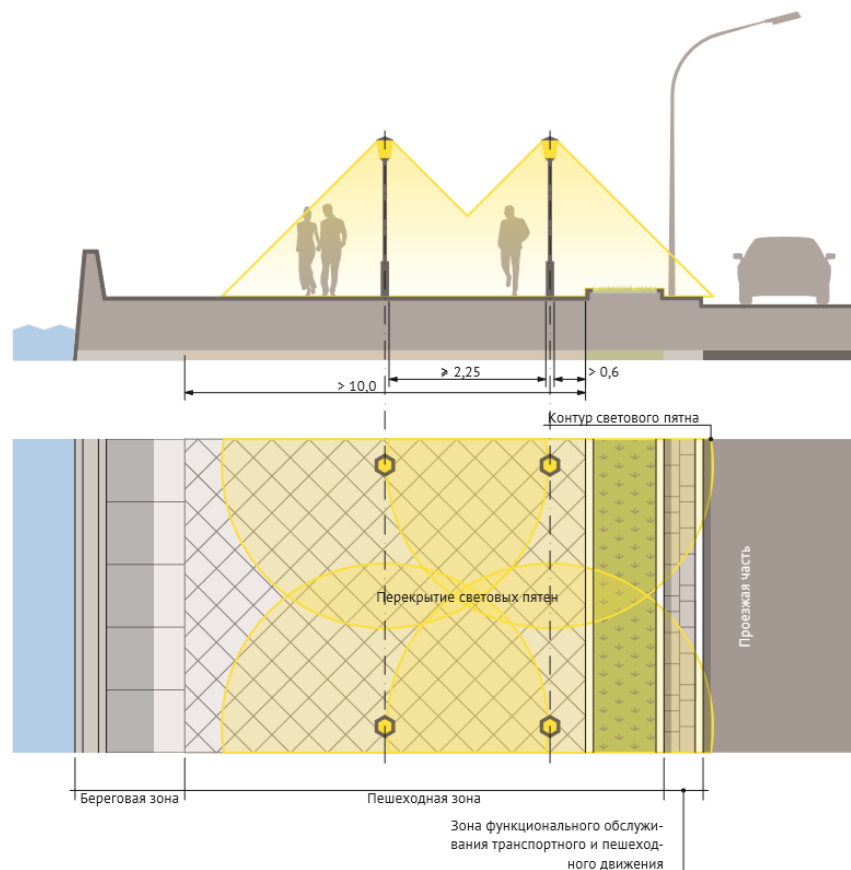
Двухрядная прямоугольная схема расположения опор освещения со стороны береговой линии набережной
